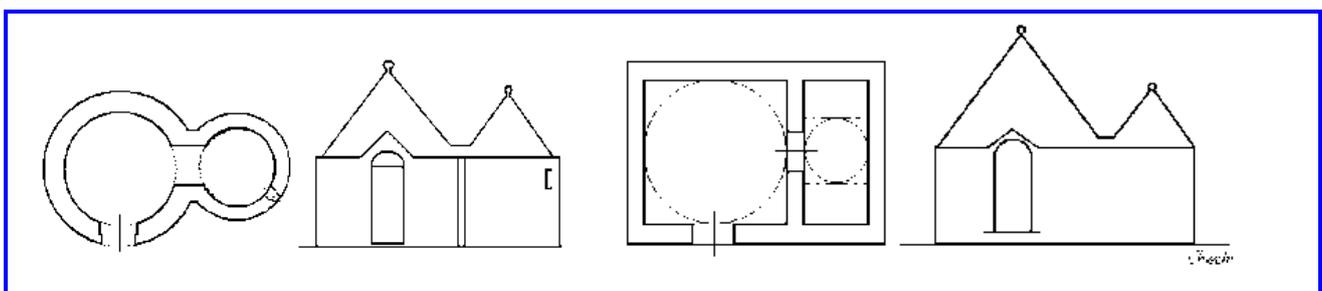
tipologie di trulli rispettivamente a pianta circolare e a pianta quadrata
